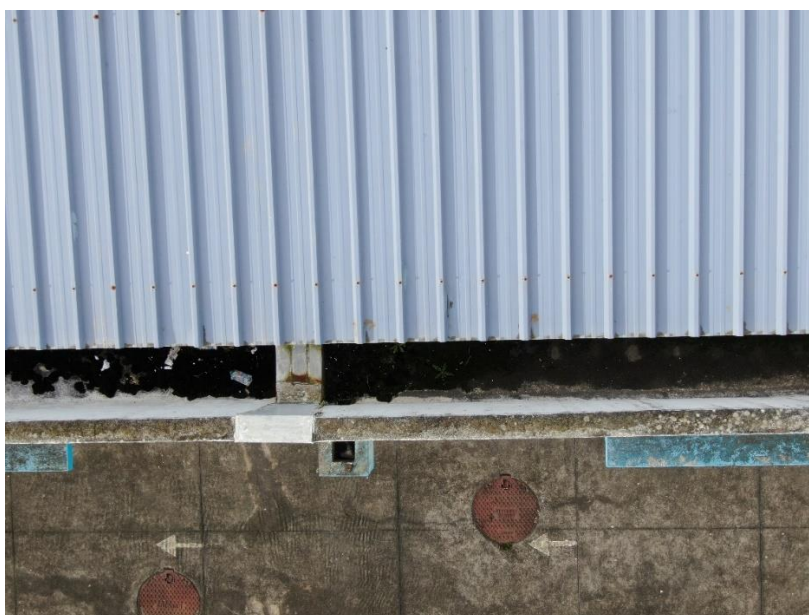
Caleira apresenta detritos e a correta falta de impermeabilização.
